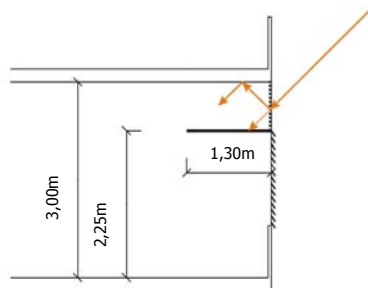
Fassadenschnitt mit vertikalem LCP im Oberlicht
